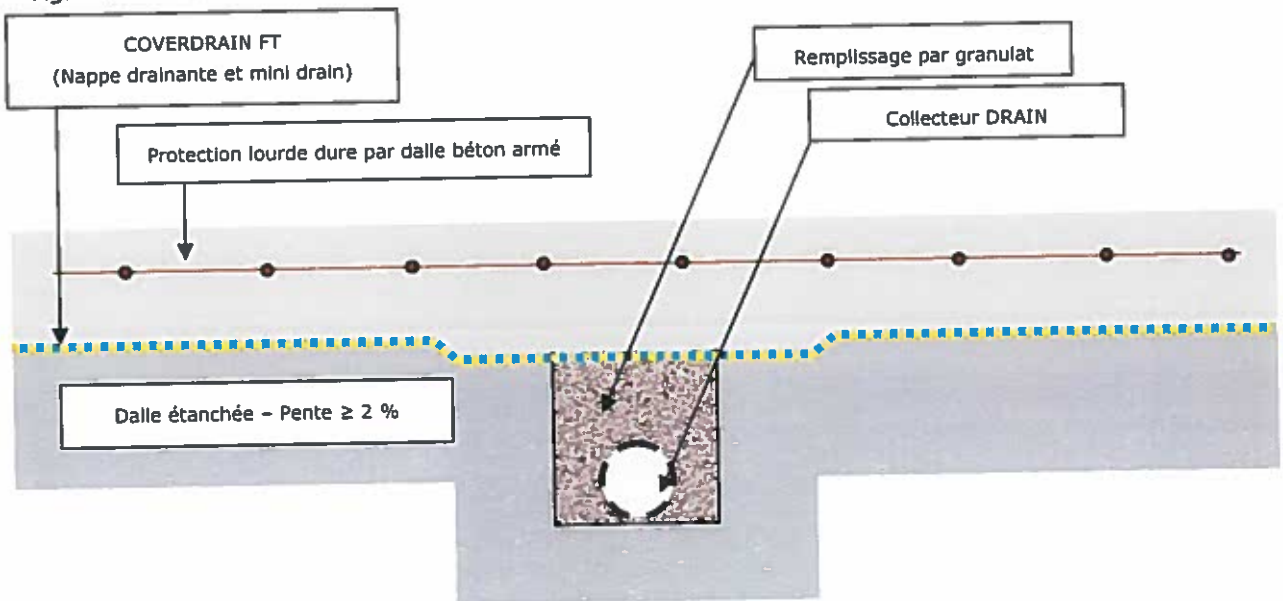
Traitement d'une noue avec caniveau filant - sous protection lourde dure en dalle béton armée
